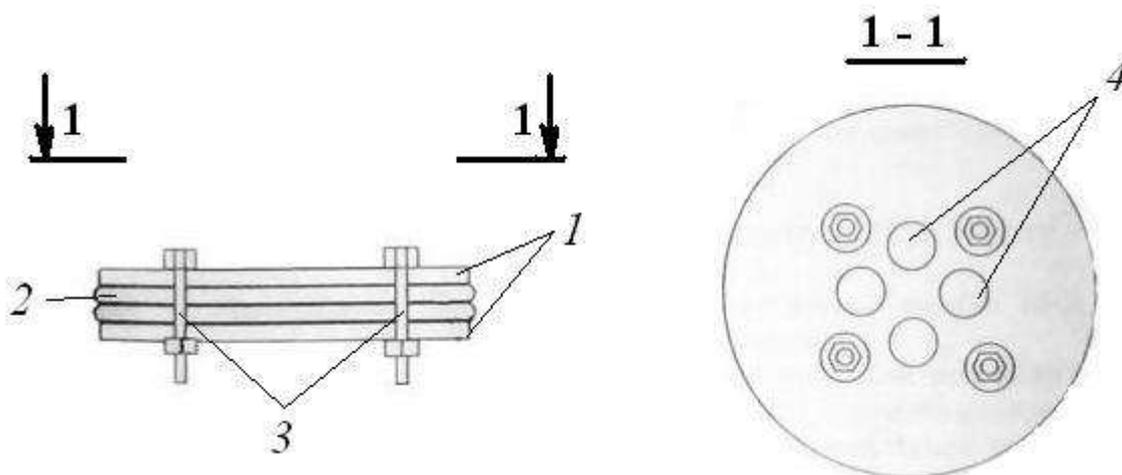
Схема устройства анкера в водонасыщенных грунтах с герметизацией скважины при шпунтовой стенке
